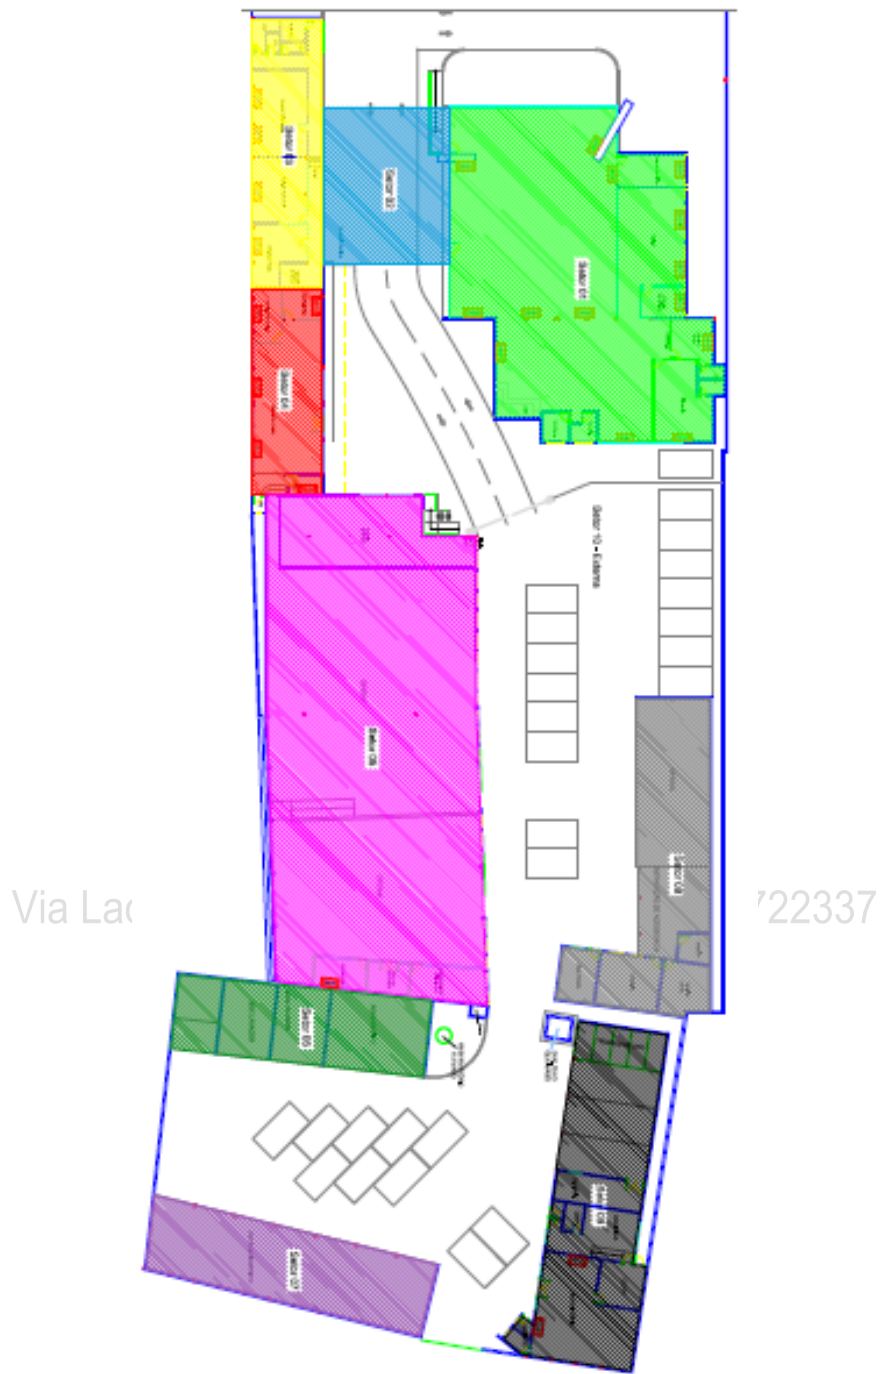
Planta Baixa – Via Láctea com setorização de consumo energético
